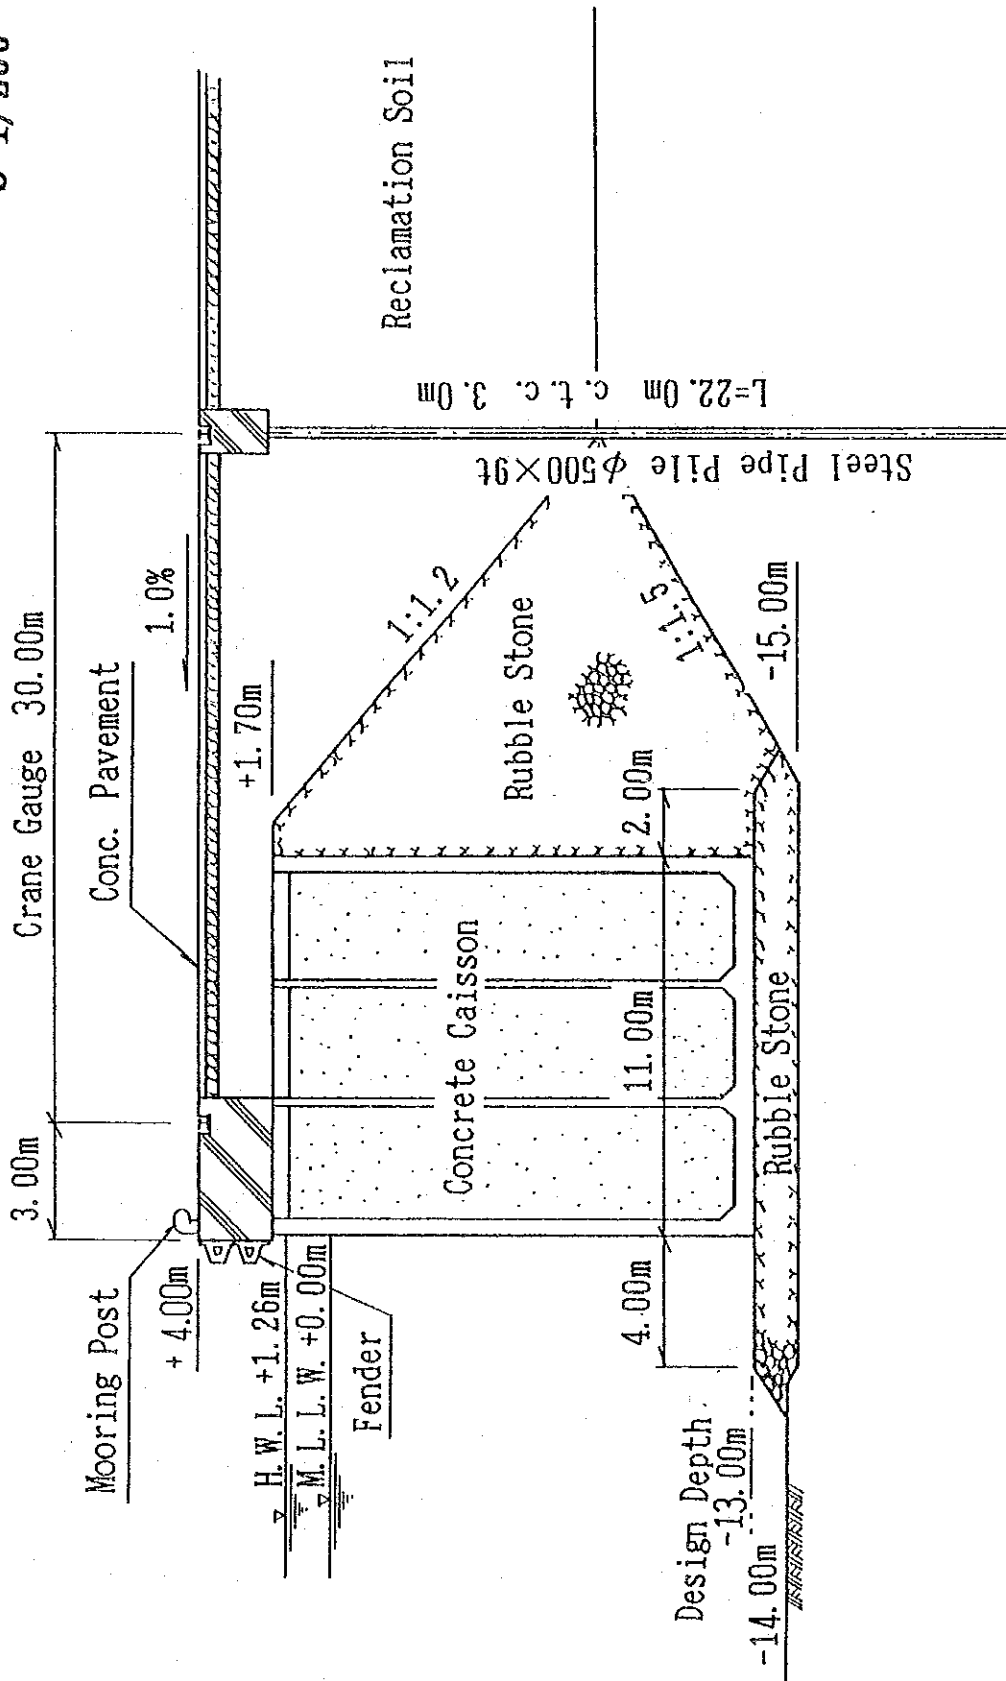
ナイク/カビテ新港-13mコンテナバース標準断面図
